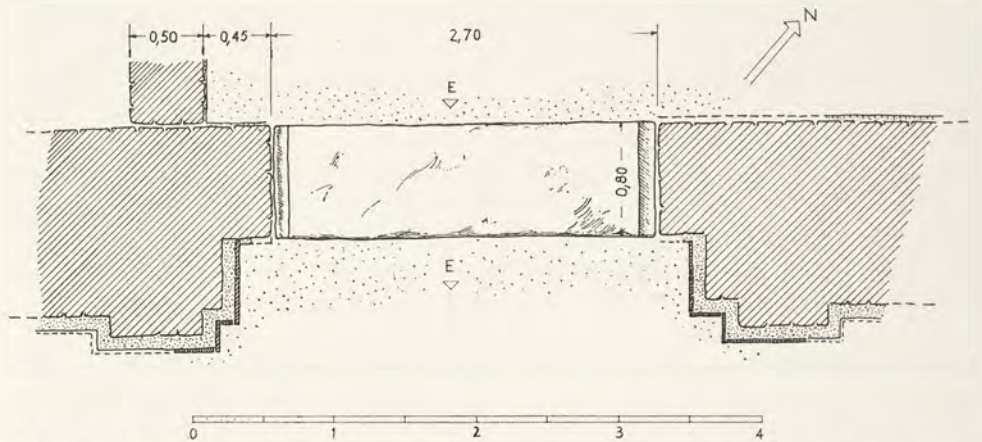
Eingang zu einem römischen Wohnhaus in der Predigerstraße; Grundriß
